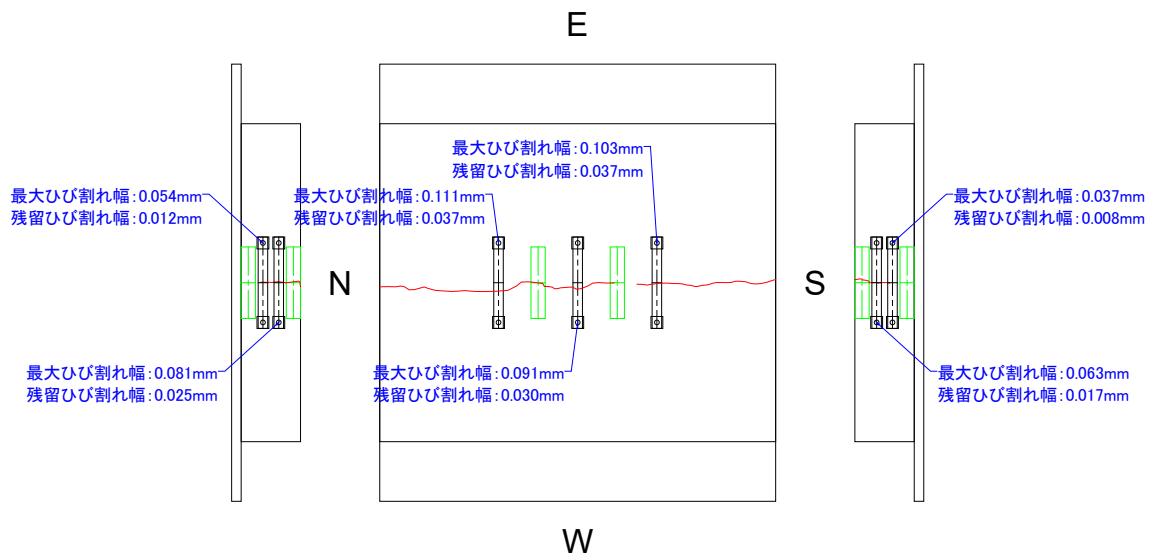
2. 2 ひび割れの発生位置と π 型変位計ごとの最大ひび割れ幅と残留ひび割れ幅
